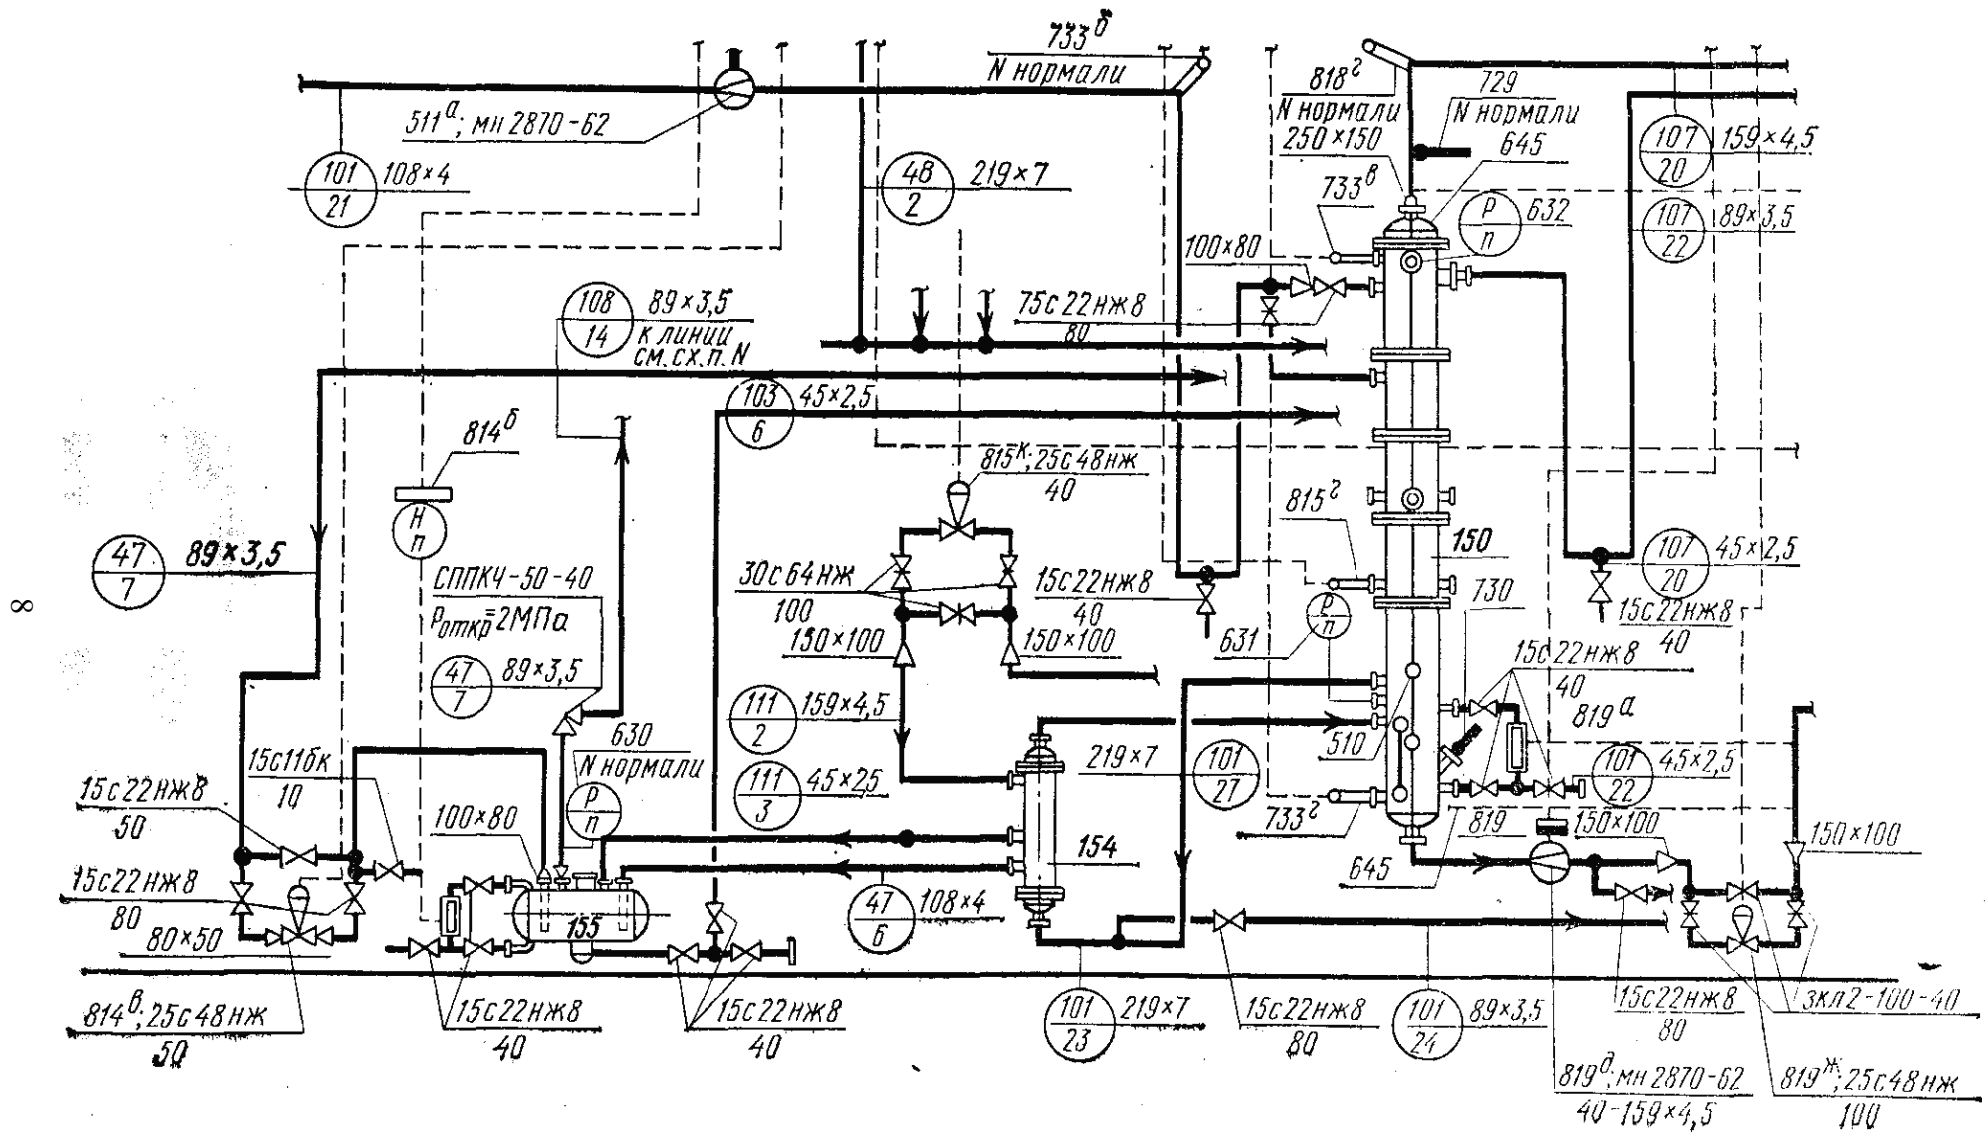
Монтажно-технологическая схема внутрицехового трубопровода
